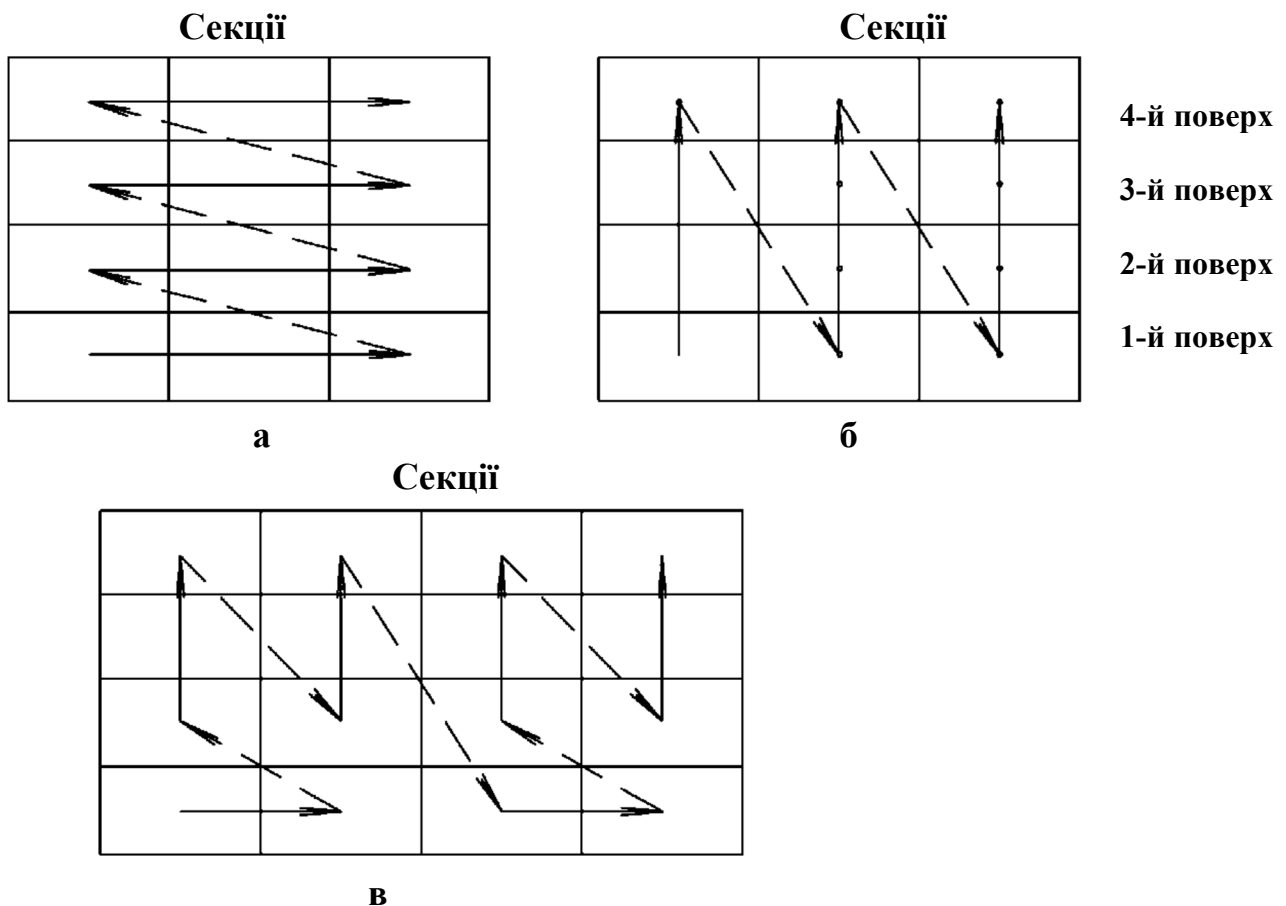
Схеми напряму монтажу багатоповерхових будівель:
